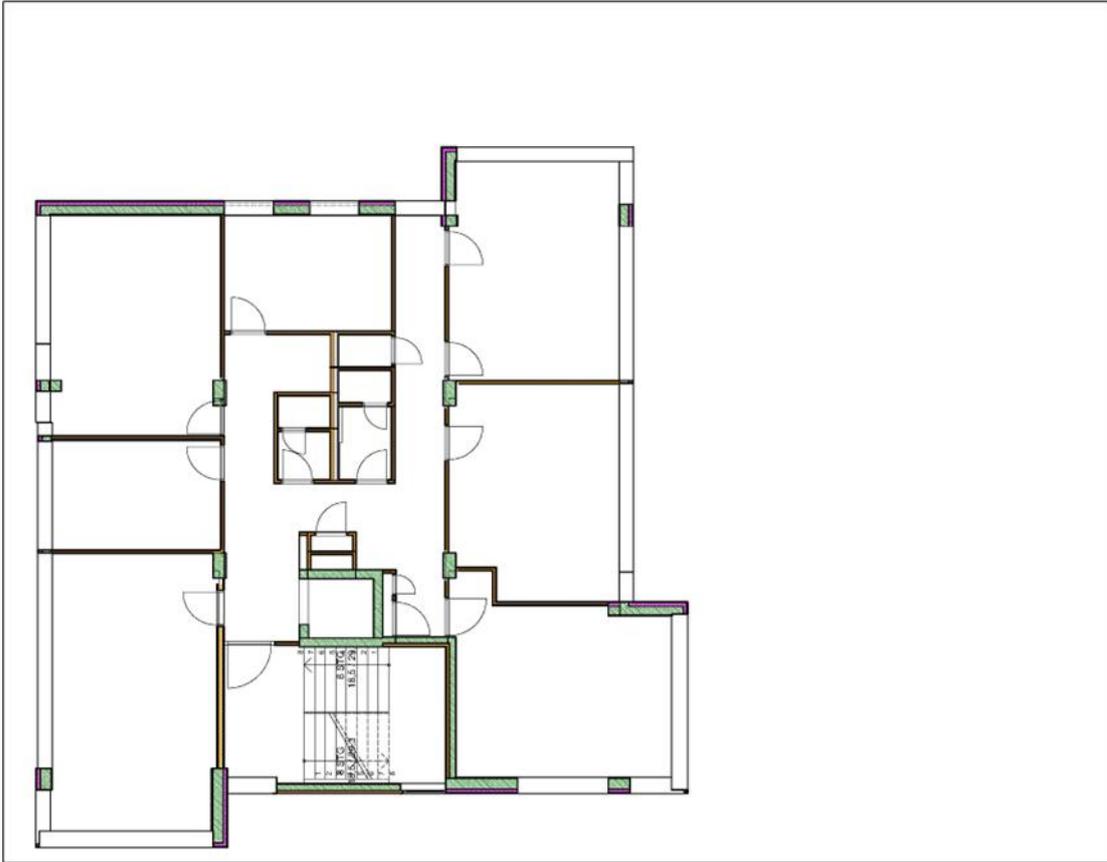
Fallbeispiel Grundriss OG5
